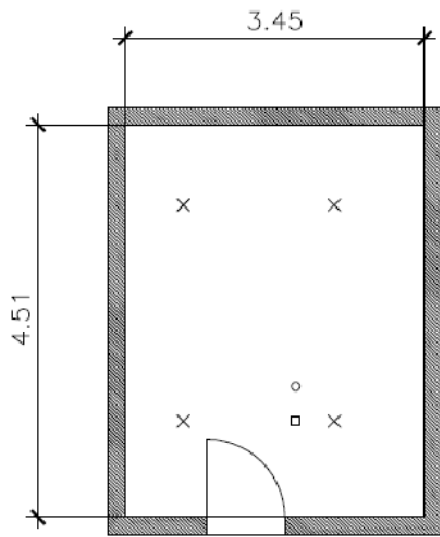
Grundriss (Skizze) Schlafzimmer
